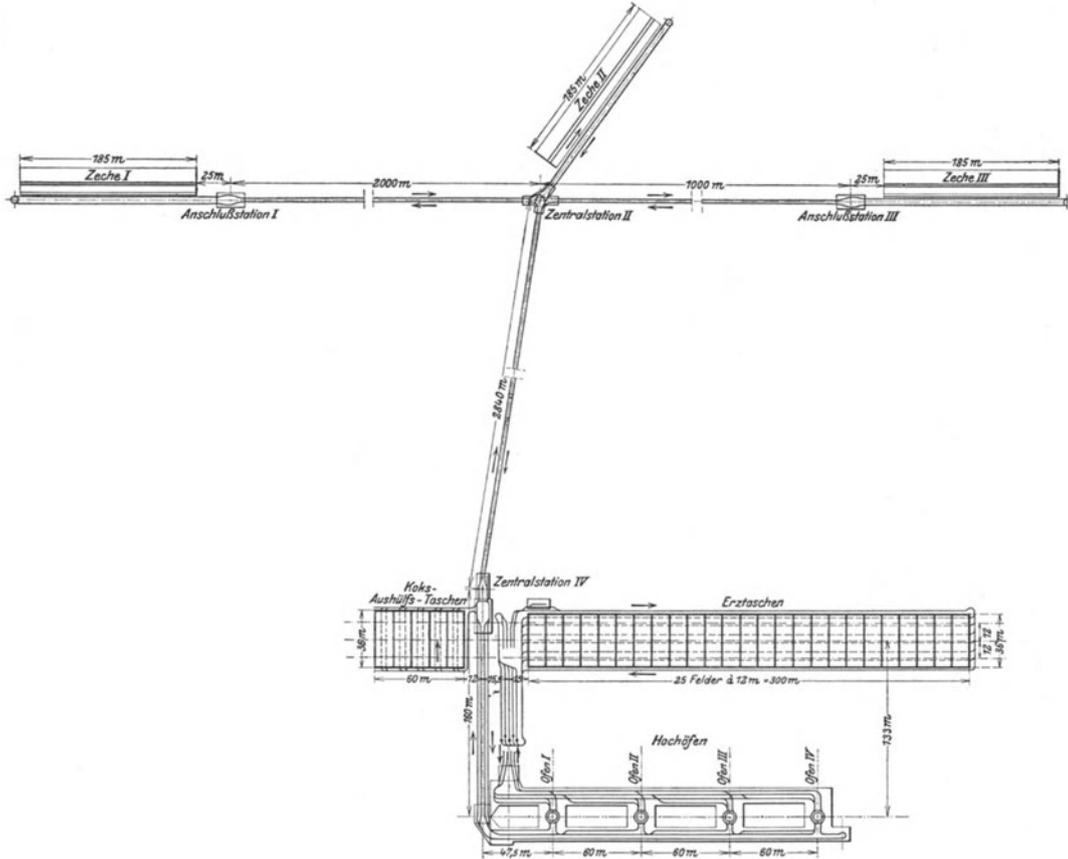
Situationsplan der Koksfernbahn (Drahtseilbahn). Zechen-Hochofenwerk.
